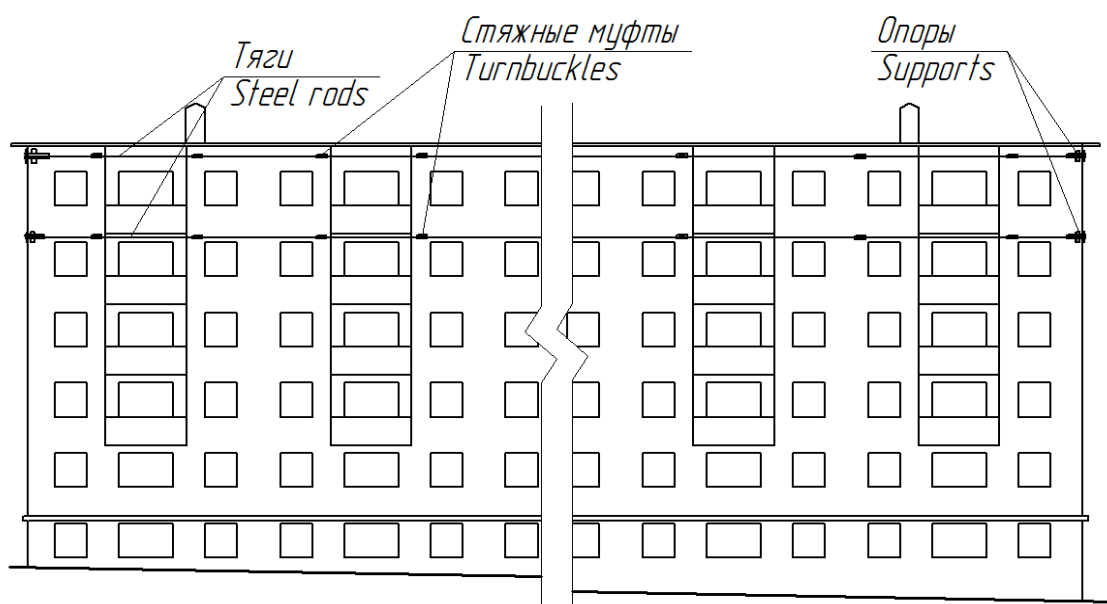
Схема расположения элементов усиления надфундаментной части здания. Уличный фасад
